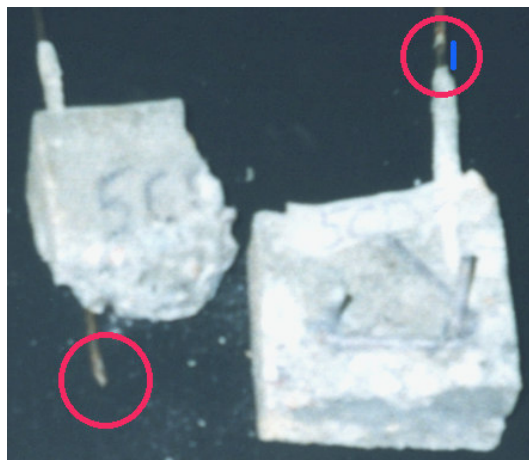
Ruptura tipo 3 – detalhe do escorregamento de uma barra e ruptura da outra
